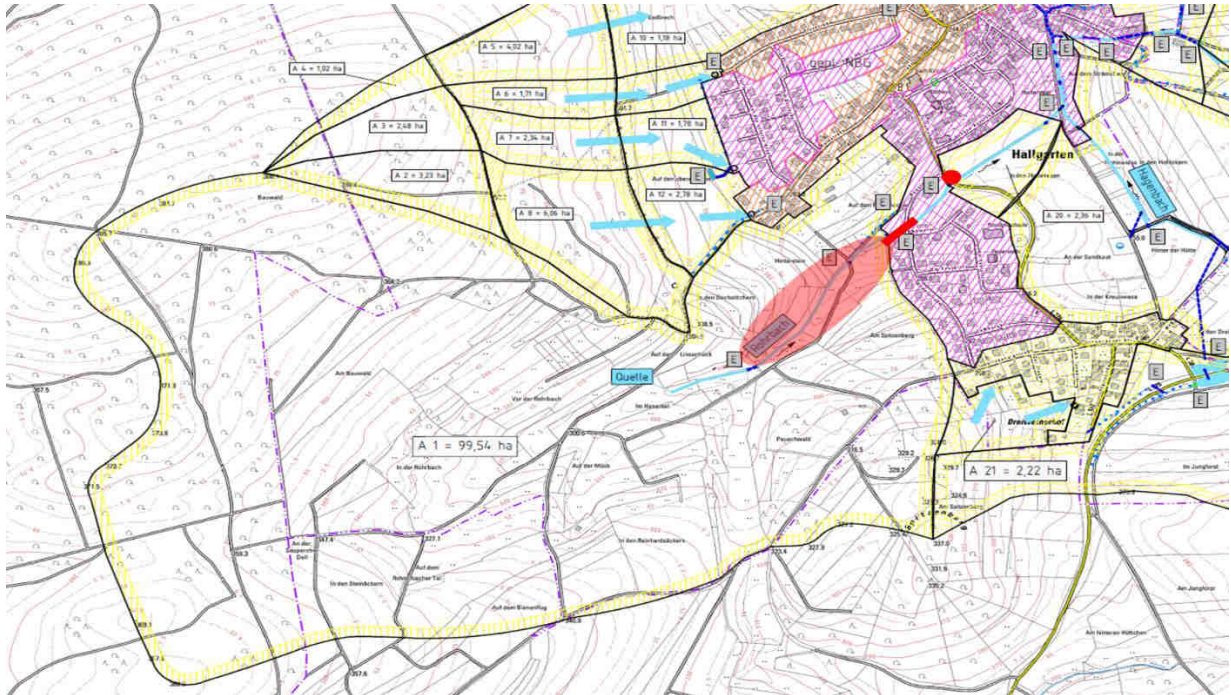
Lageplanausschnitt Oberlauf bis L376
